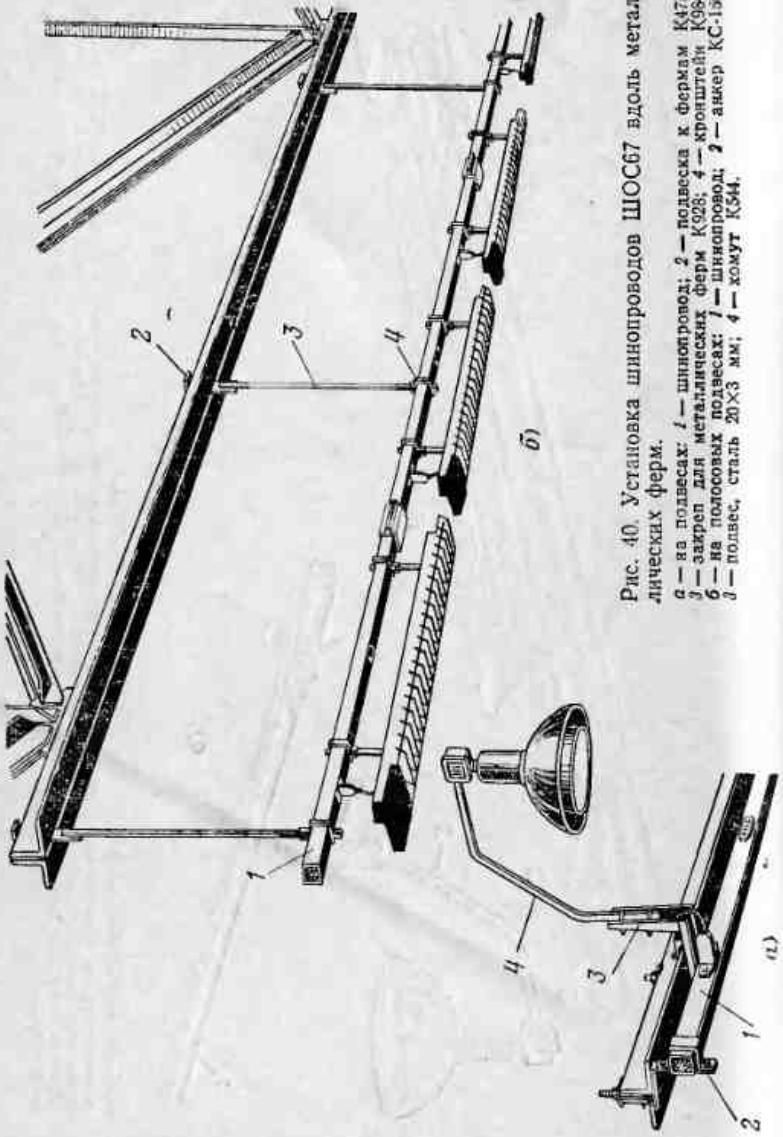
Установка шинопроводов ШОС67 вдоль металлических ферм.
